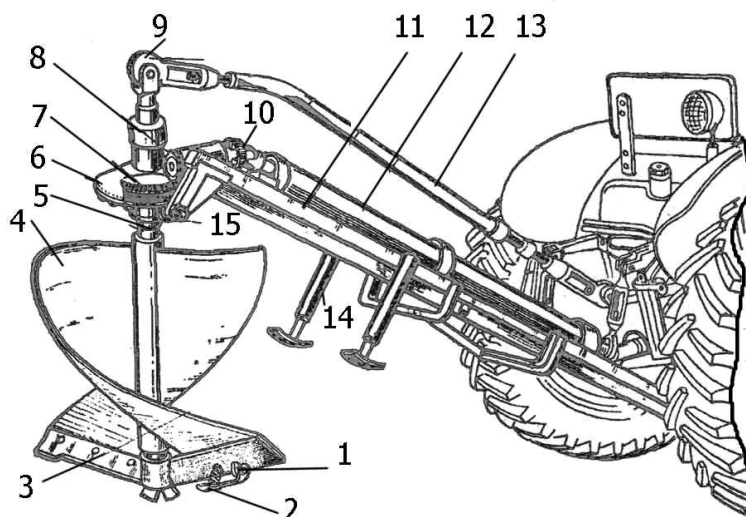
Копатель ям универсальный КЯУ-100: 1 – регулировочный болт; 2 – опорная пятка; 3 – лемех; 4 – шнек бура; 5 – вертикальный вал; 6 – корпус редуктора; 7,8 – большая и малая конические шестерни; 9 – верхний шарнир; 10 – карданная передача; 11 – брусья рамы; 12 – кожух; 13 – верхняя тяга; 14 – выдвижные пятки; 15 – нижний шарнир
